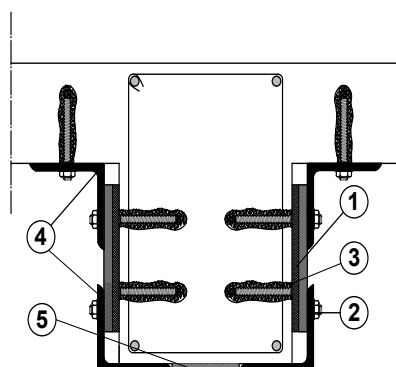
Tipologia 8: representação da secção transversal da viga reforçada. Legenda: 1 – resina epóxi; 2 – chapa metálica; 3 – bucha metálica; 4 – cantoneira de aço.
